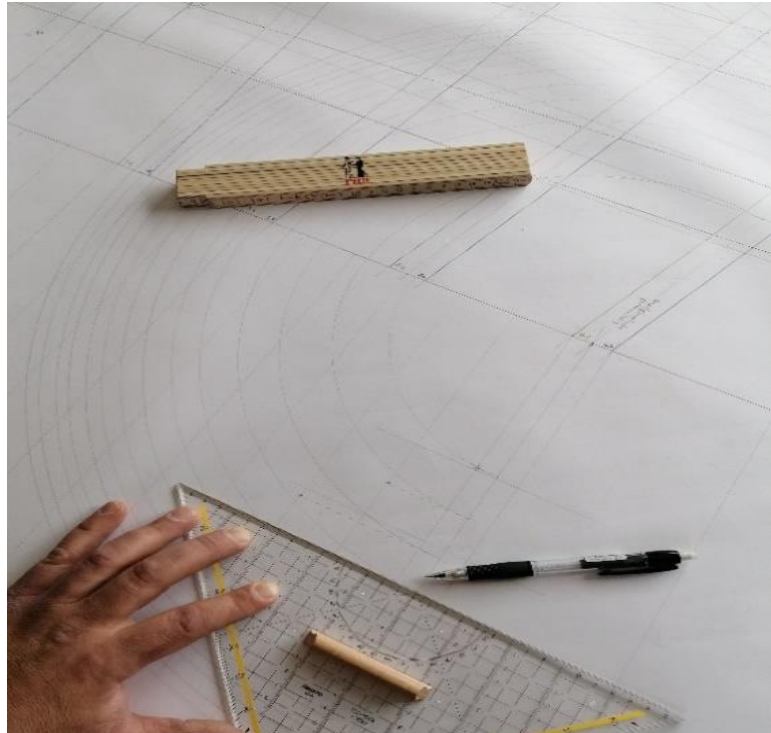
Sehr platzsparend aber wenig übersichtlich: Die Dachfläche ist abgeklappt und „liegt“ auf Grundriss und Profil.
